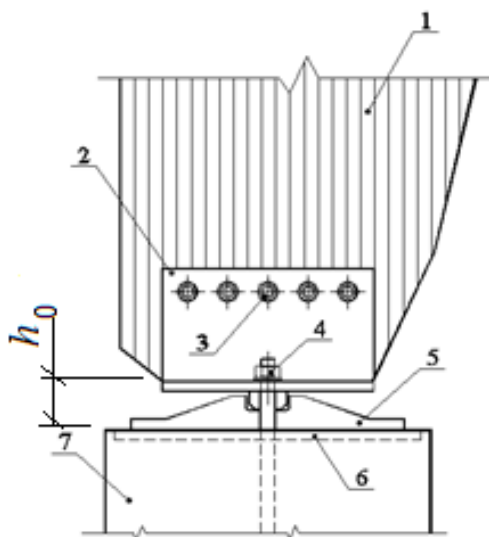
Схема узла соединения стойки рамы с железобетонной опорой
